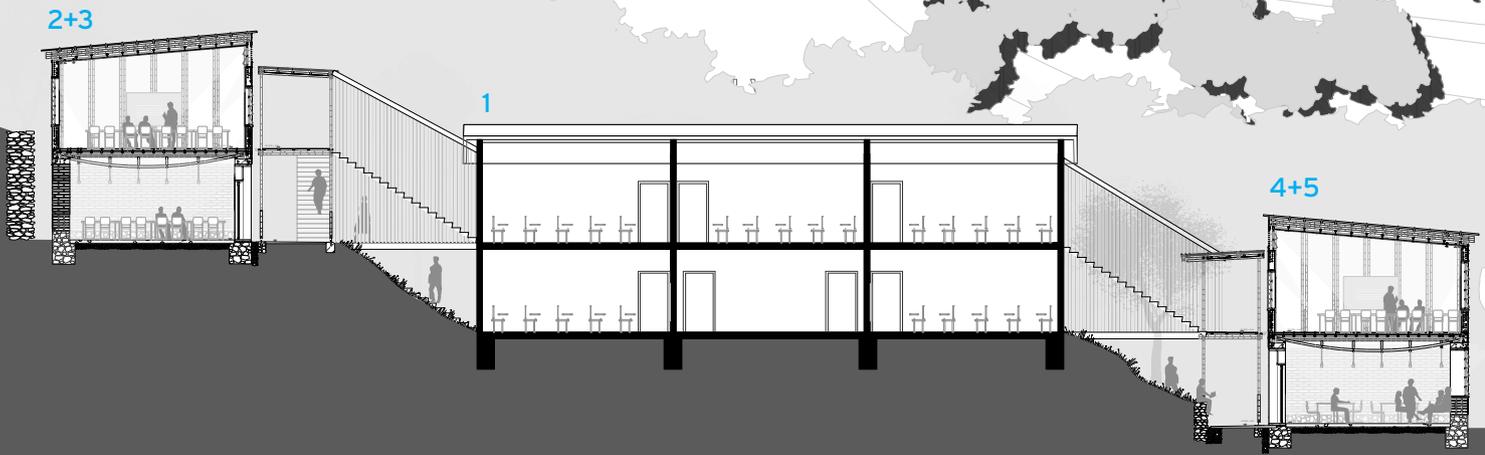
Grundriss des Campus; Bauabschnitte 1-5
